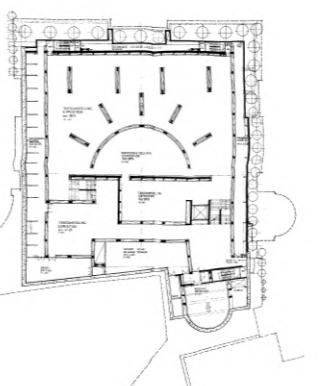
Plan du troisième niveau sous la place du Musée, 1^{ère} esquisse de la phase I.
